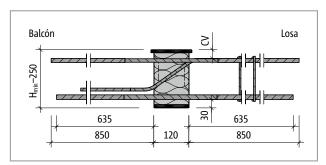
Schöck Isokorb® XT tipo K-M12 hasta M13: Sección del producto
